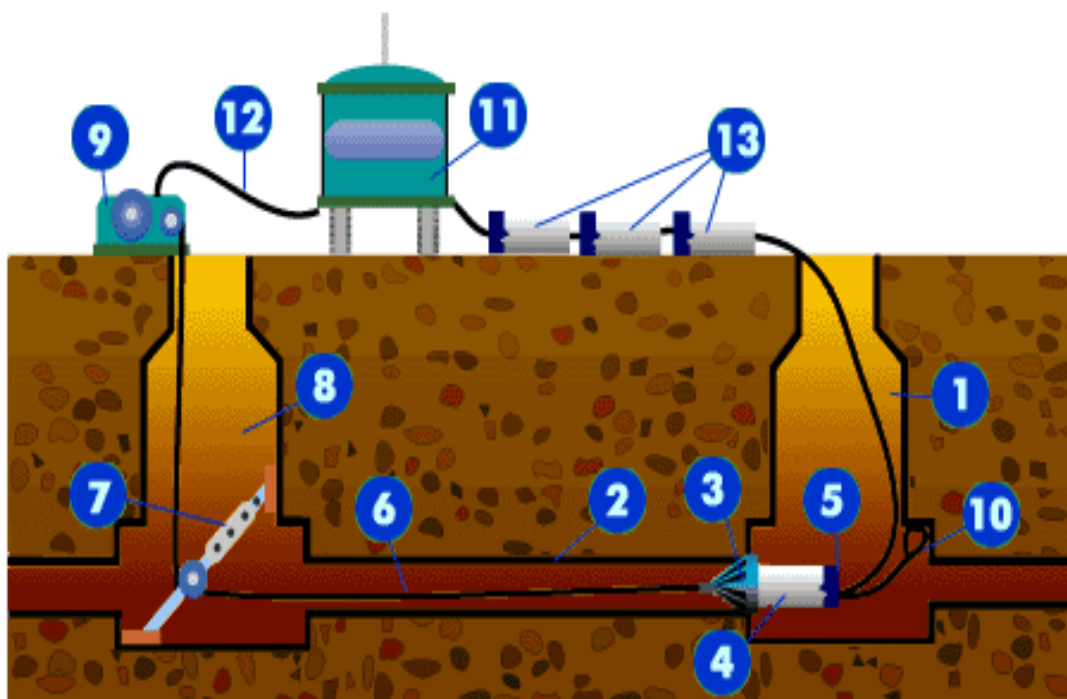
Схема капитального ремонта трубопровода с помощью гидравлического разрушения: 1, 8 – стартовый колодец; 2 – рабочий орган; 3 – расширитель; 4 – пневмопробойник; 5 – заменяемая труба; 6, 10 – тяговой трос; 7 – отклоняющий анкер; 9 – лебедка; 11 – передвижной компрессор.
